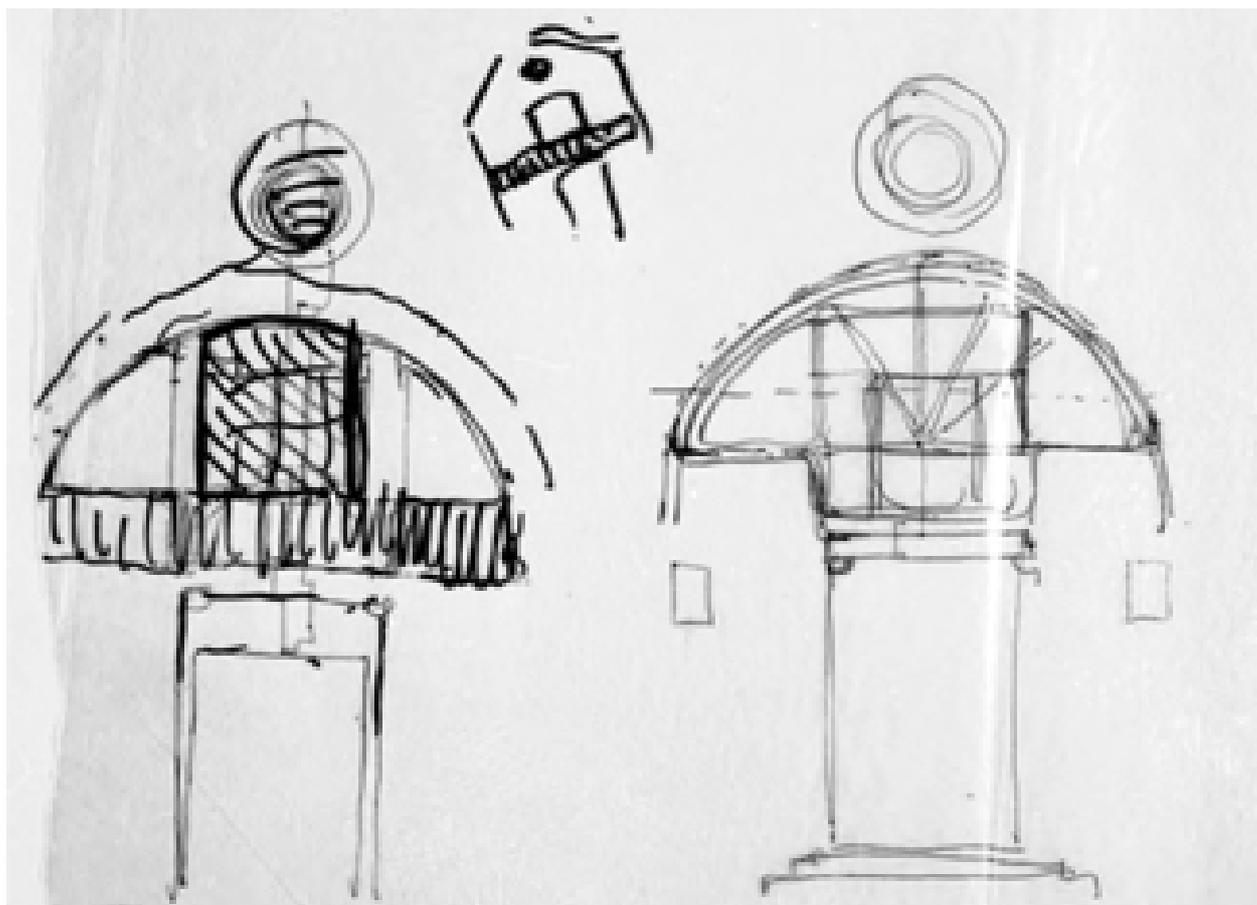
Prospetto - s.d. (AFMGF-1662)
